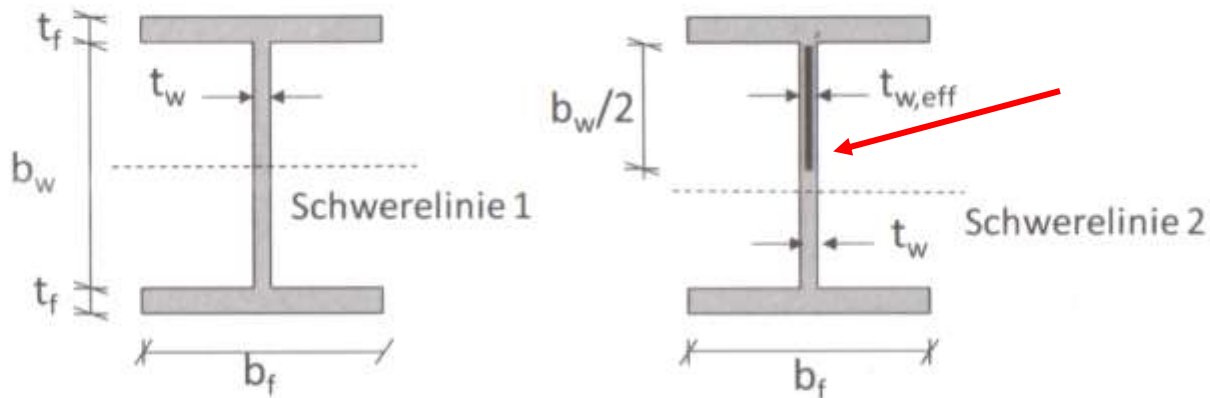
Wirksamer Querschnitt eines Biegeträgers mit Steg der Klasse 4
